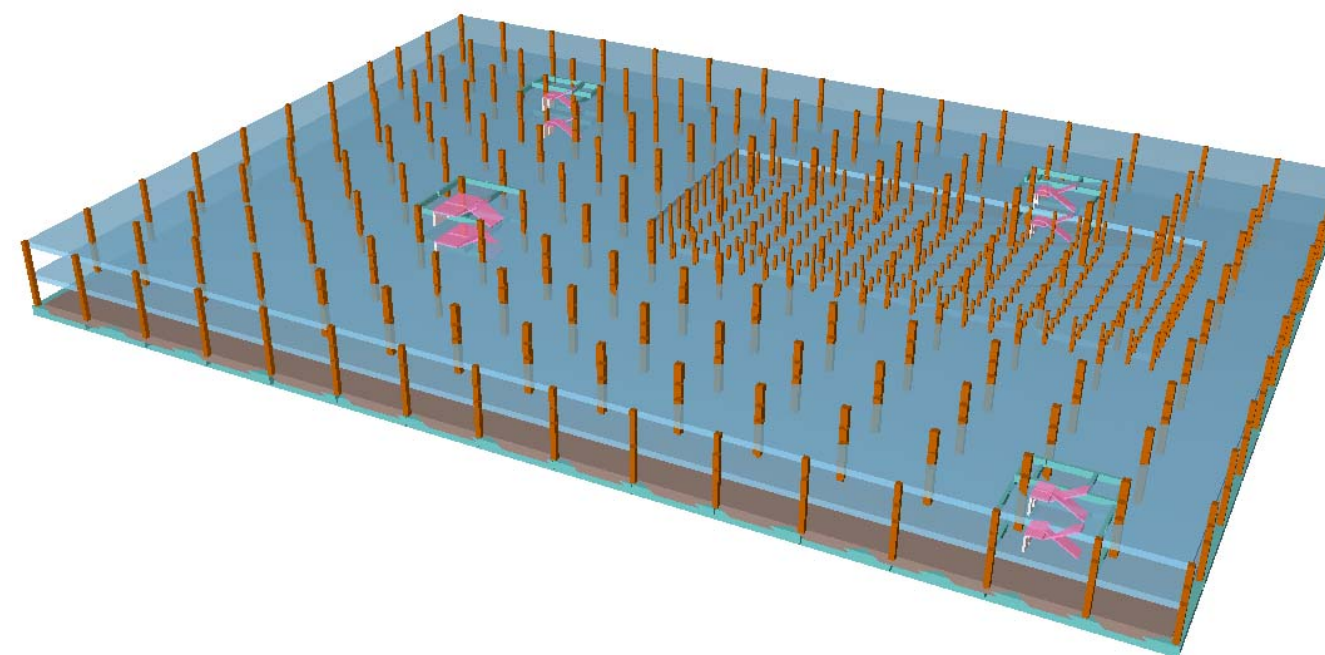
Modelo 3D sin muros. Fuente: Propia
